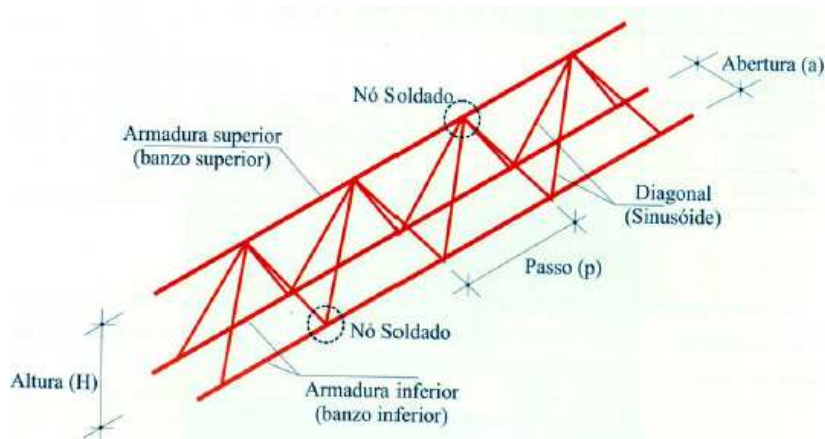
Armadura da vigota em forma de treliça espacial.
